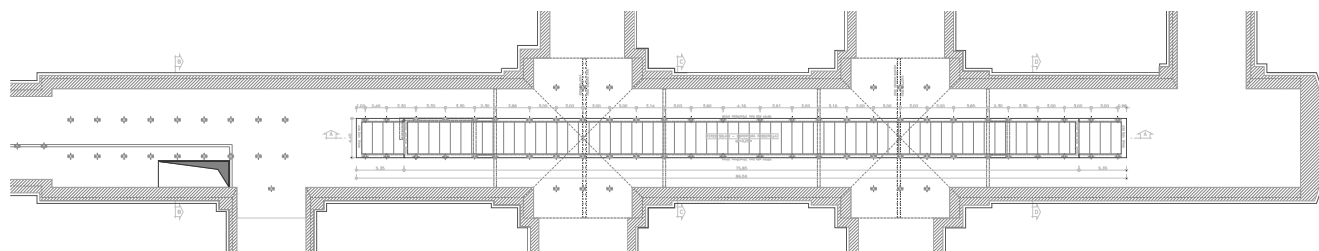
pianta terzo solaio (copertura passaggio pedonale)
